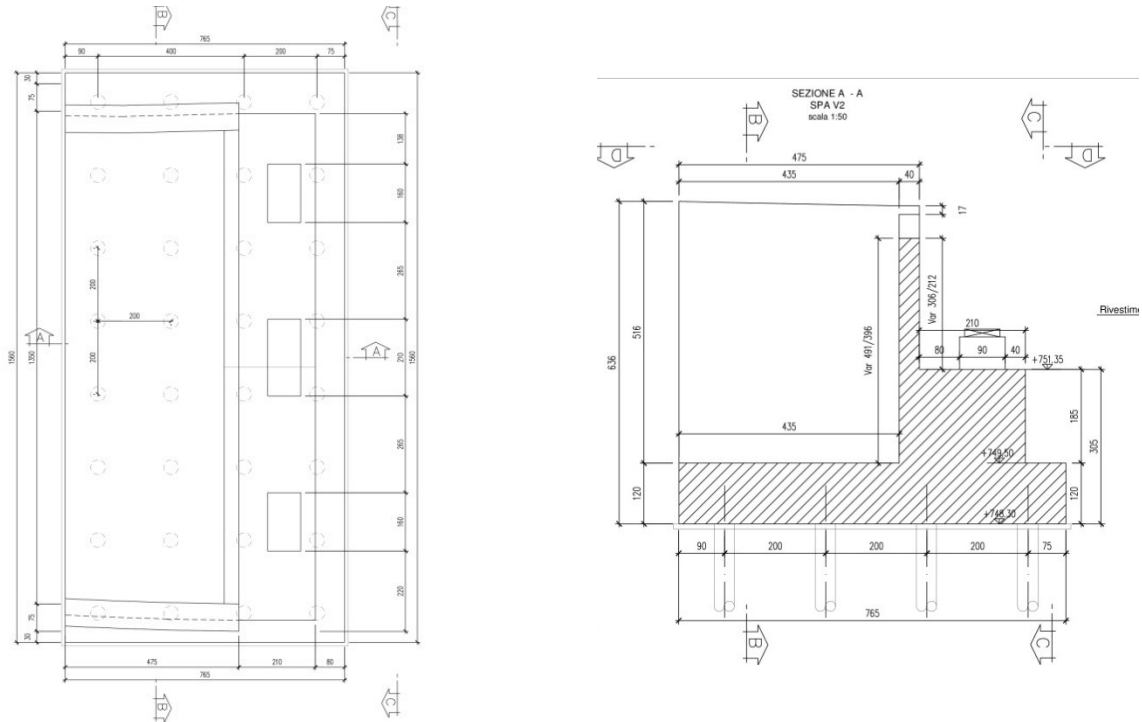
Spalla A: sezione longitudinale e pianta
